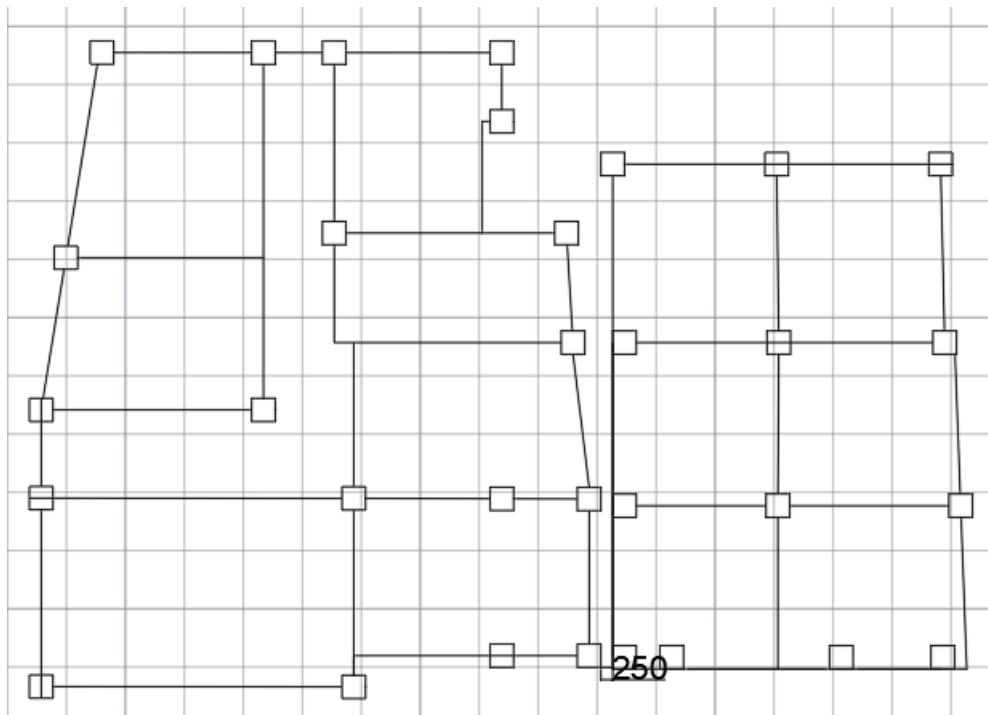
Jarak 150 mm Antara Bangunan A dengan Bangunan B.1
